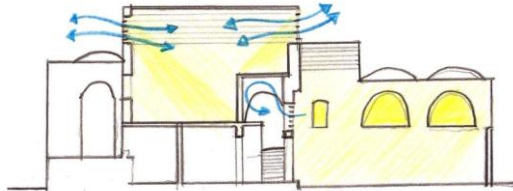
Secciones longitudinales v transversales. Greiss House
